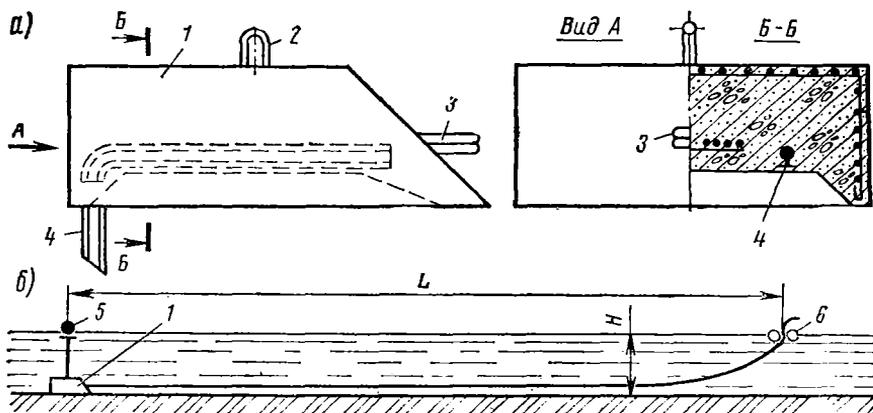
Железобетонный якорь-присос и схема его установки:
